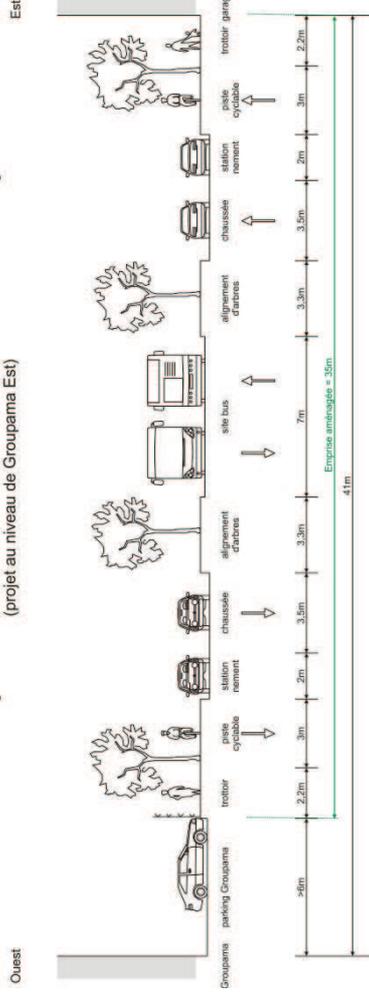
Situation projetée (coupe 23) sur le futur prolongement de la rue de Hochfelden
